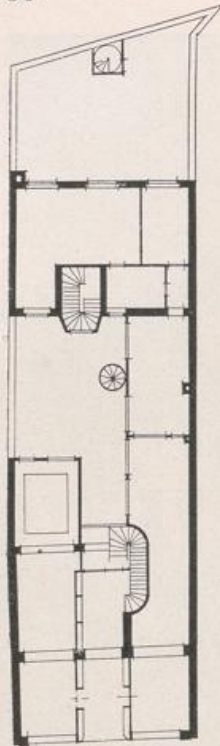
Schadowstrasse 47. Erdgeschoss. 1:500.
